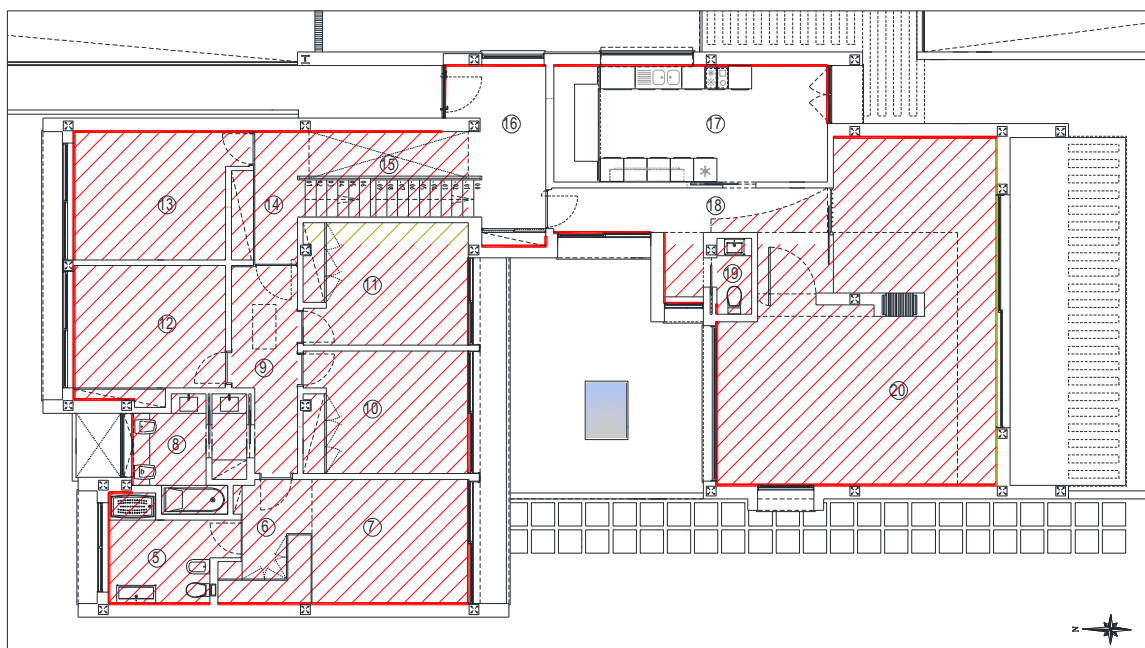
Planta do piso 0 com a delimitação da envolvente ao nível do teto.
